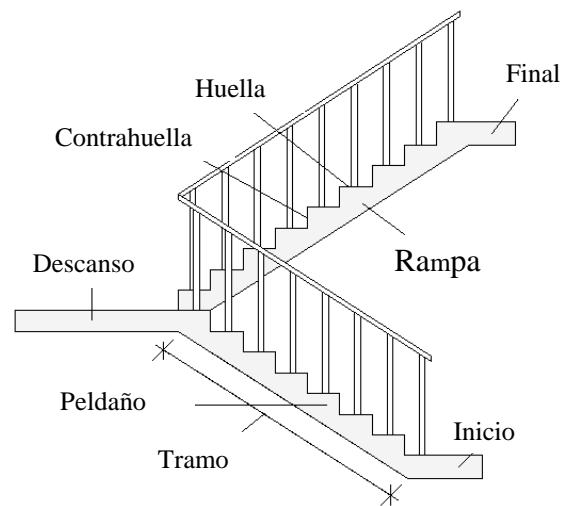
Planta de Escalera (Fuente: Plano Arquitectónico F.D.M.Ú.T.D.T.)
